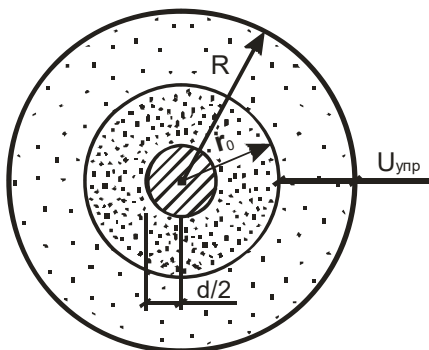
Схема формирования зон уплотнения вокруг ствола сваи
